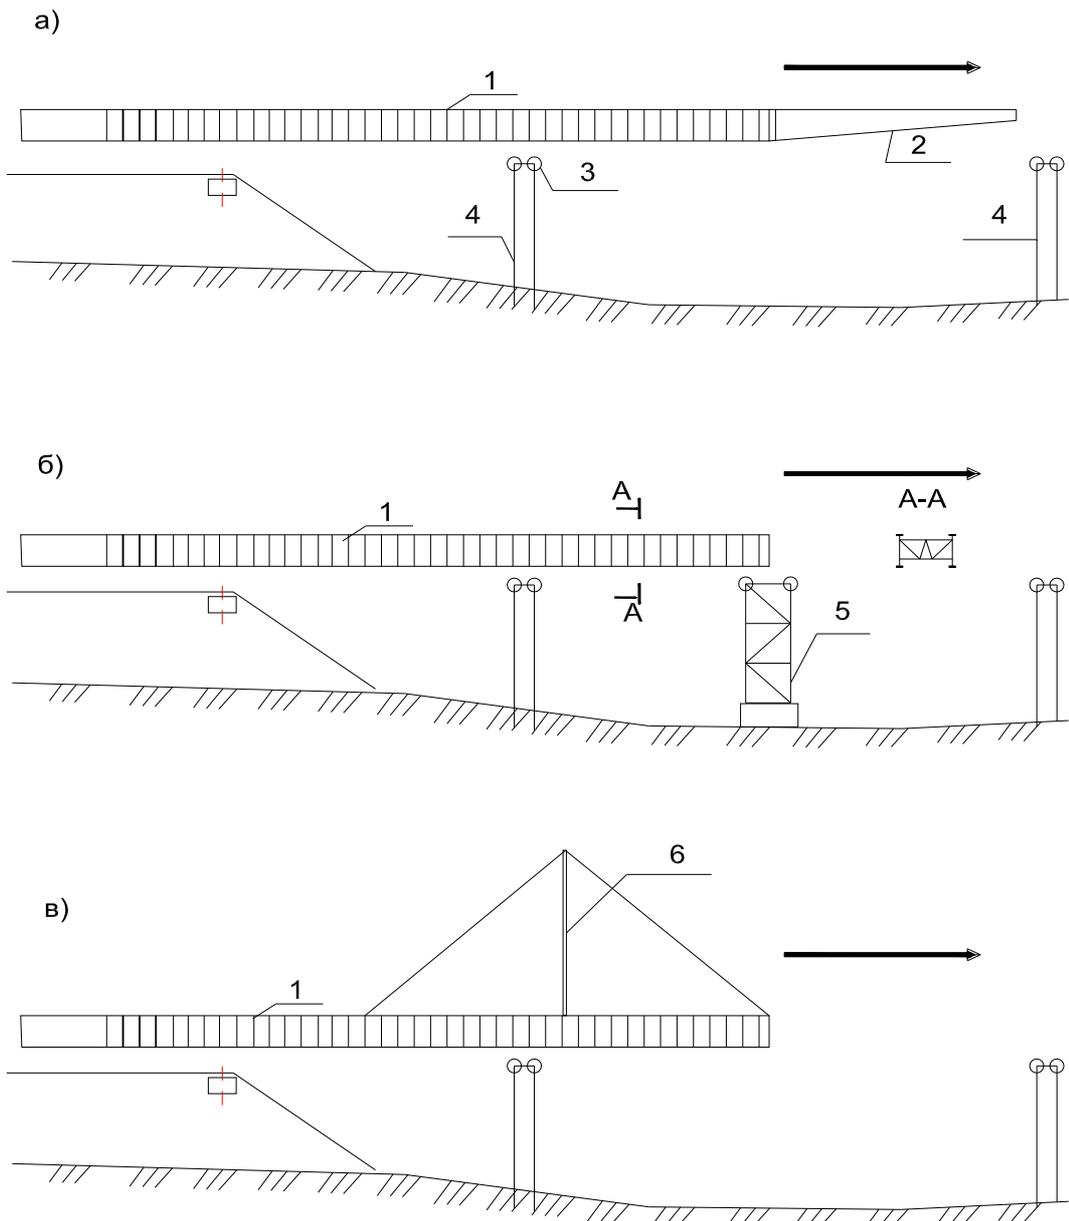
Схемы монтажа металлической части балочных неразрезных сталежелезобетонных пролетных строений: а- продольная надвигка по постоянным опорам с аванбеком; б -продольная надвигка по постоянным и временным опорам; в-продольная надвигка с усилением шпренгелем. 1-надвигаемая стальная конструкция; 2-аванбек; 3-накаточные устройства; 4-постоянная опора; 5-временная опора; 6-шпренгель
